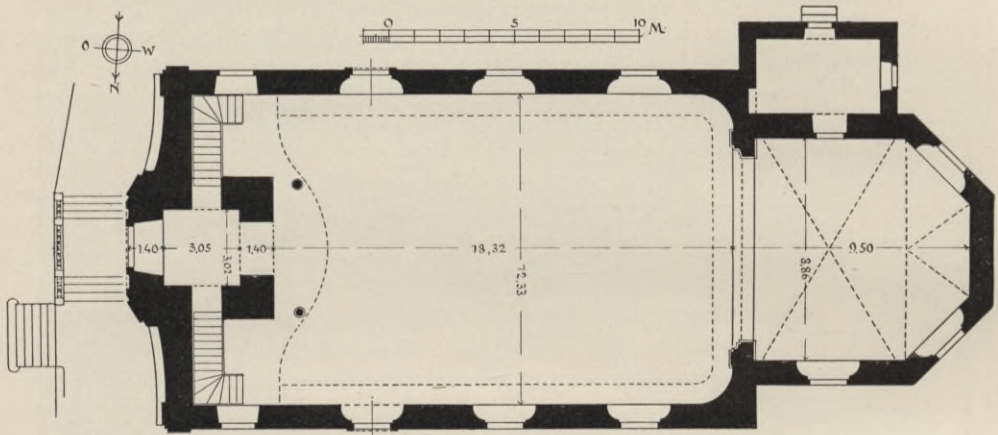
Gauaschach. Grundriß der Pfarrkirche.
